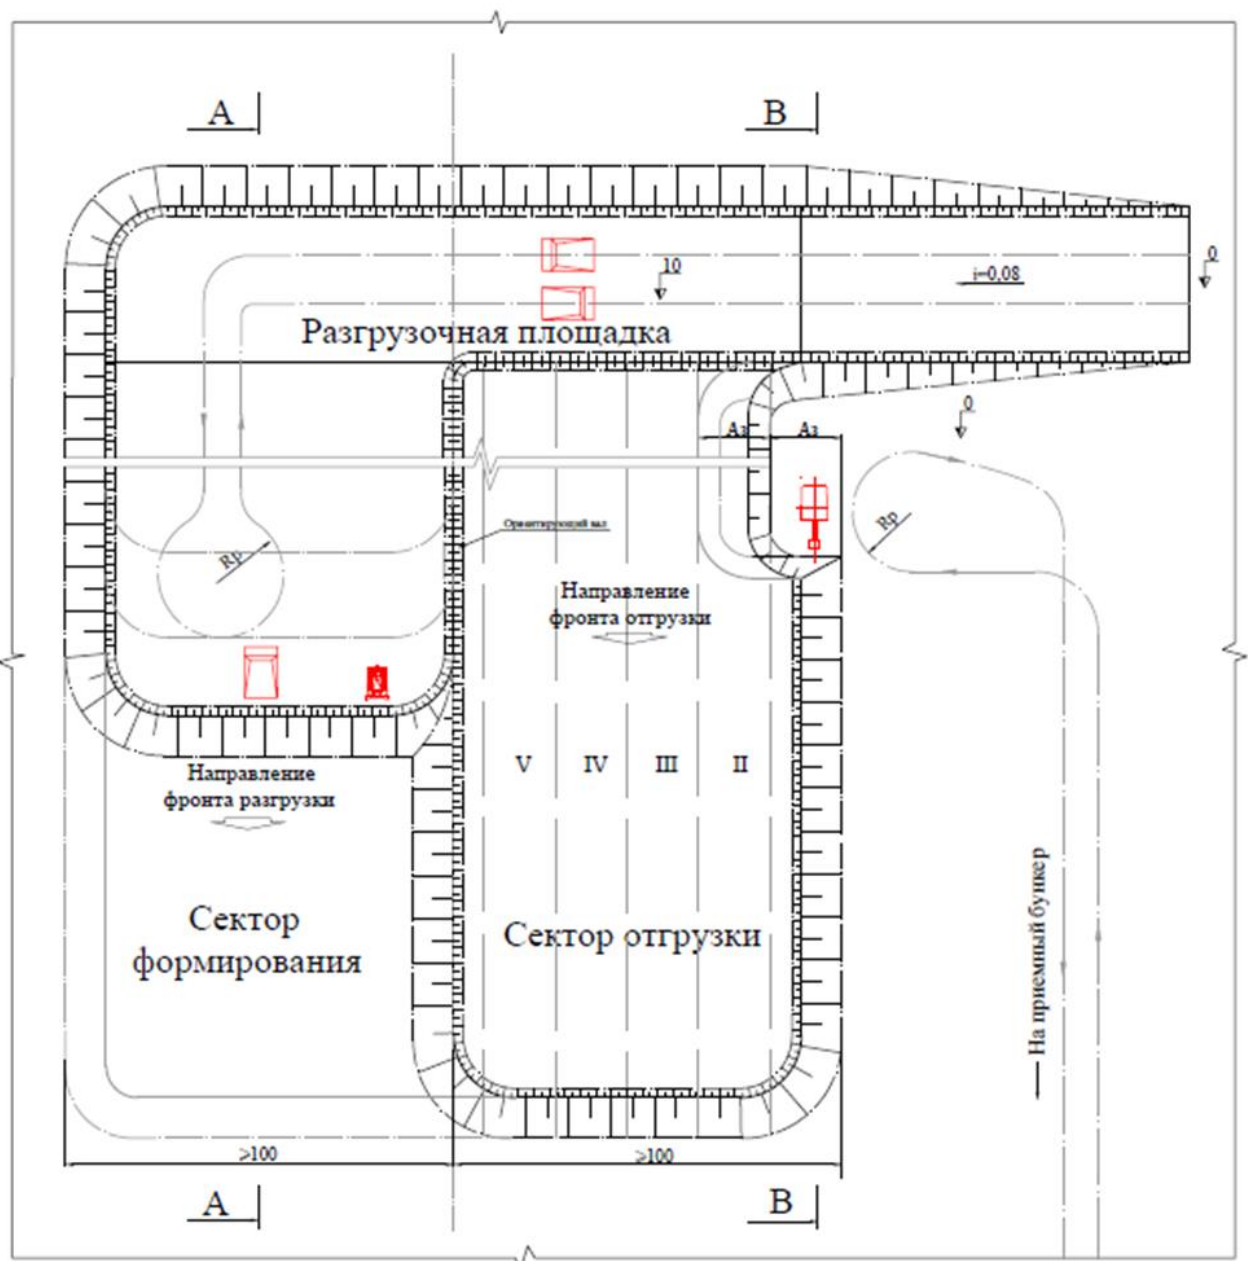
Схема формирования штабелей усреднительного склада наклонными слоями с отгрузкой в крест напластования слоев
